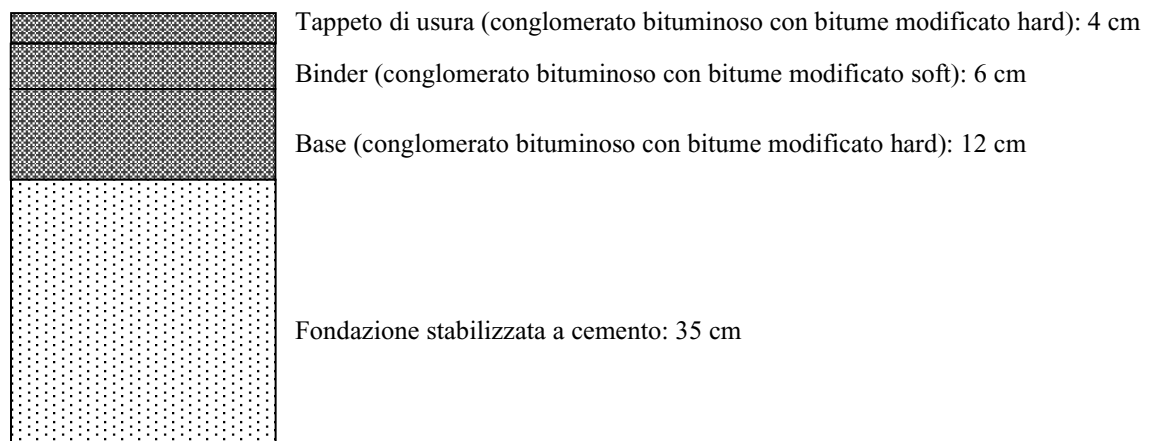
Pavimentazione con base a caldo e usura chiusa
